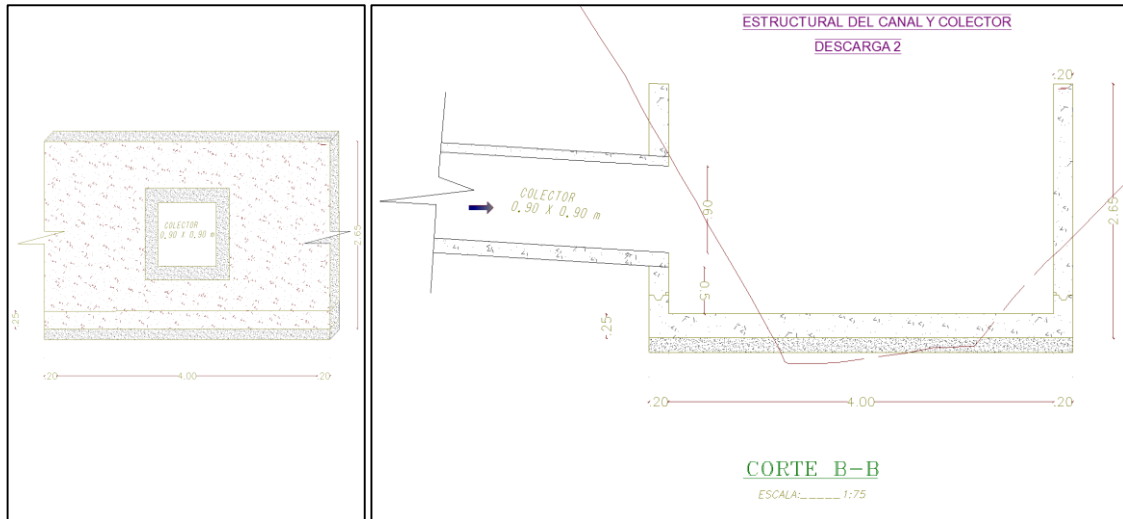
Vista en planta del muro de descarga del pozo 312
